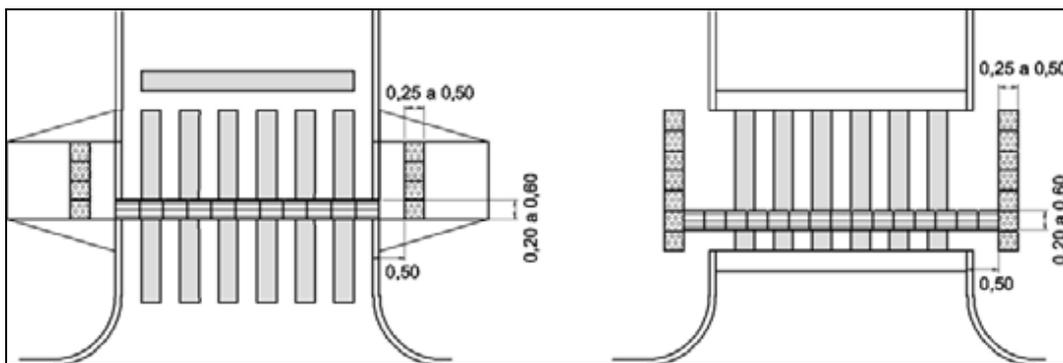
Rebaixamento de calçada (esq.) e Faixa elevada (dir.)
